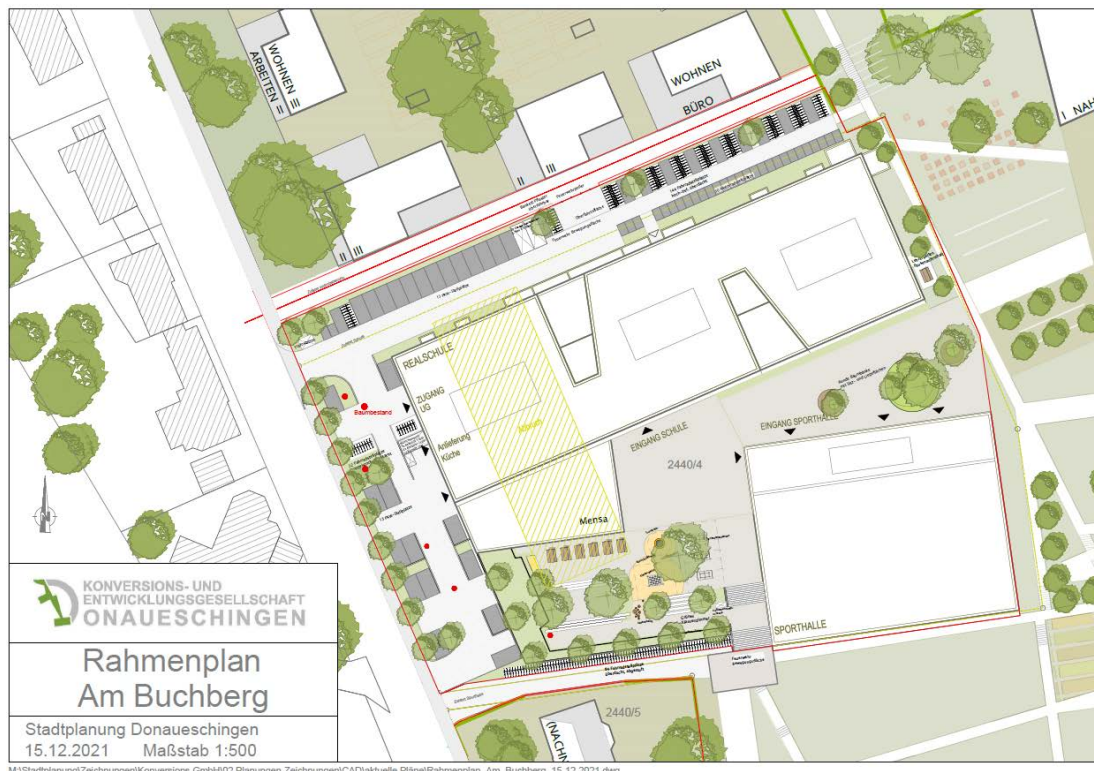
Rahmenplan mit den zu fällenden Bäumen (Markierung durch roten Punkt)
